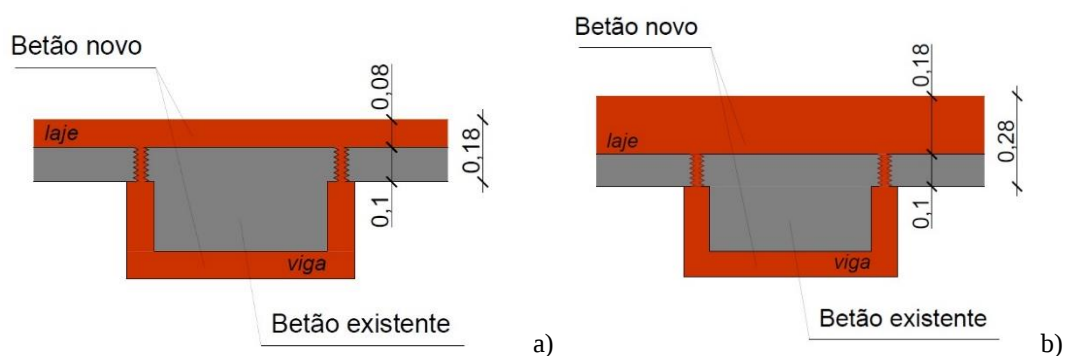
Solução de reforço de vigas: a) no teto do piso -1; b) no teto do piso 0
